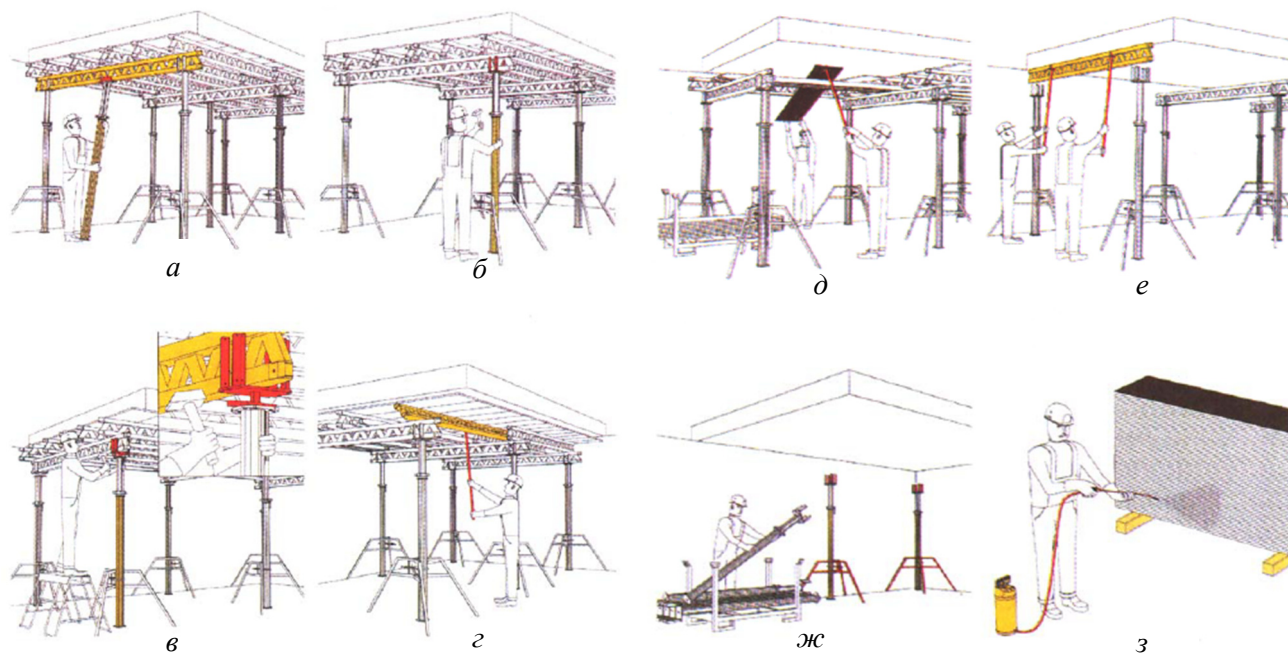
Последовательность демонтажа горизонтальной опалубки
